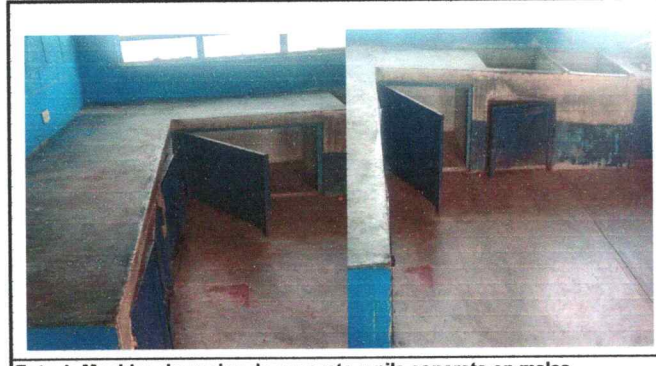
Muebles de cocina de concreto y pila concreto en malas condiciones falta azulejo
